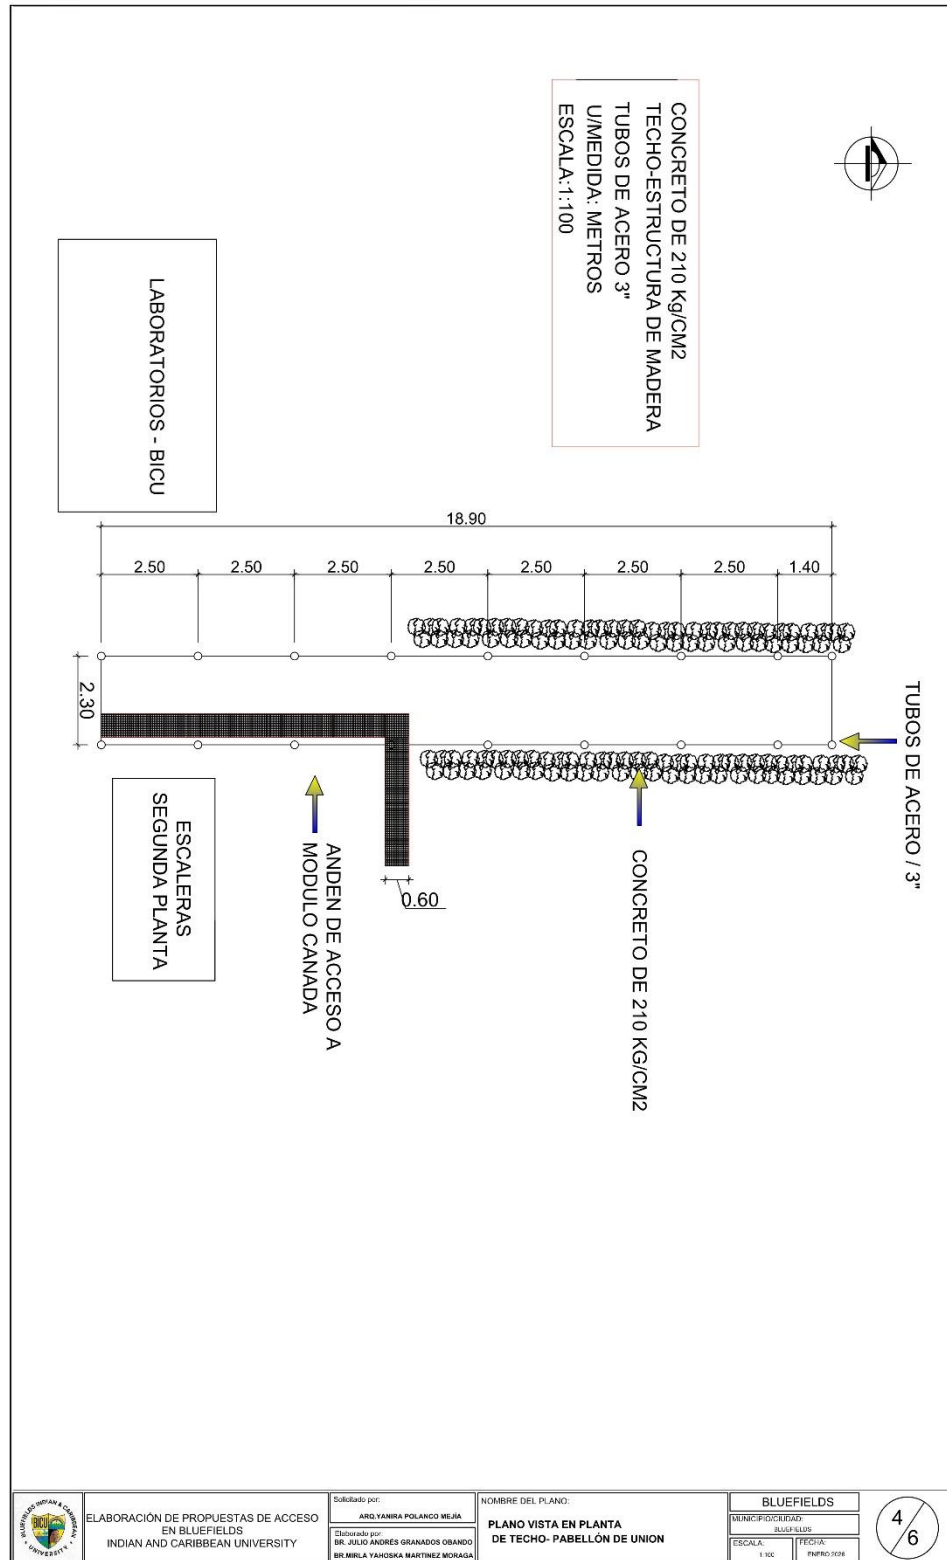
Vista en planta de conexión entre módulos, sede BICU
